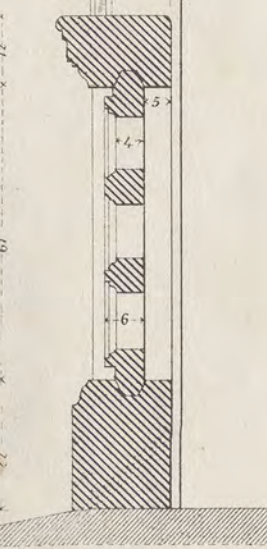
<sup>a</sup> Parapetto della finestra del secondo piano.
